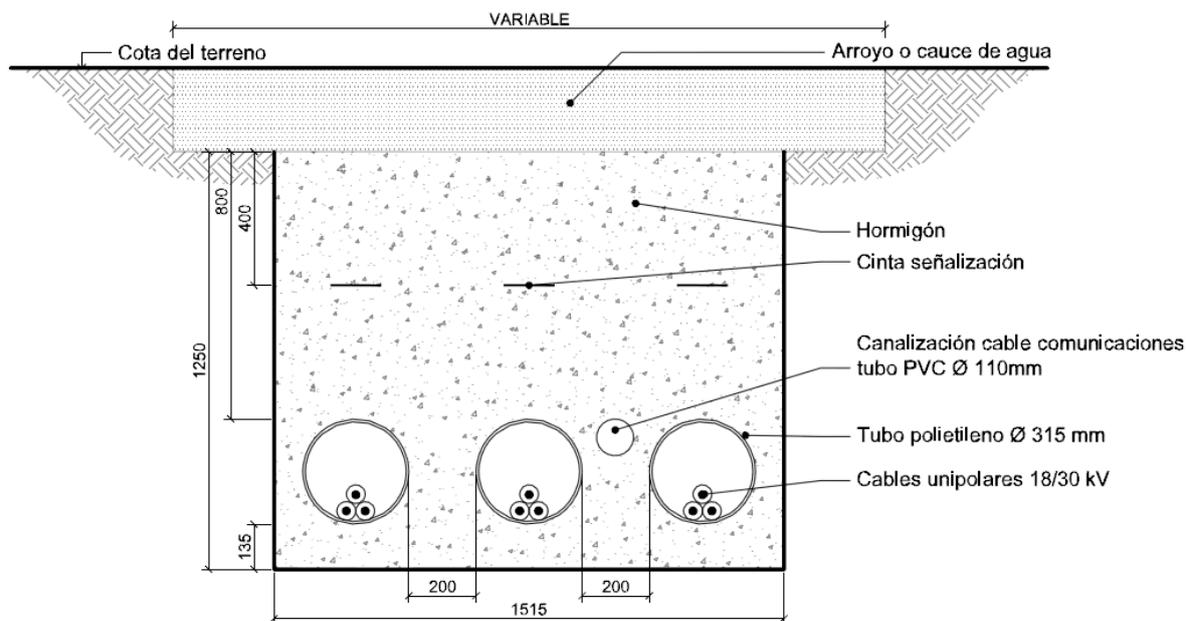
Canalización Hormigonada Tres Conductores/Fase bajo Arroyo
